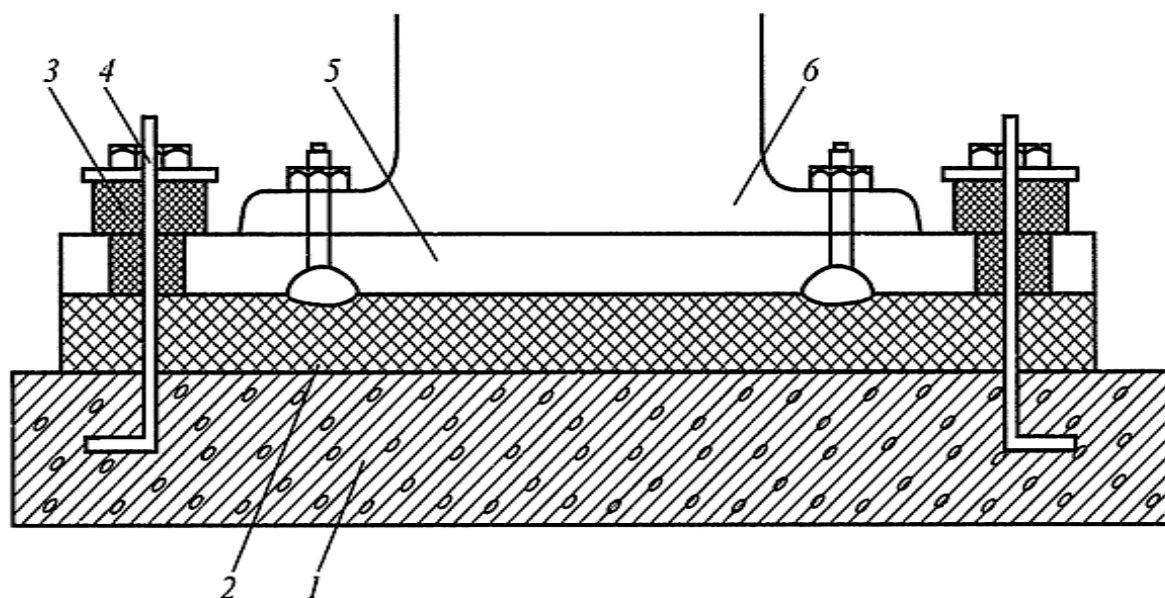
Установка агрегата на фундамент через виброизолирующую прокладку: 1 — фундамент; 2 — виброизолирующая прокладка; 3 — виброизолирующая втулка; 4 — анкерный болт с гайкой; 5 — плита; 6 — опорная конструкция силового агрегата
